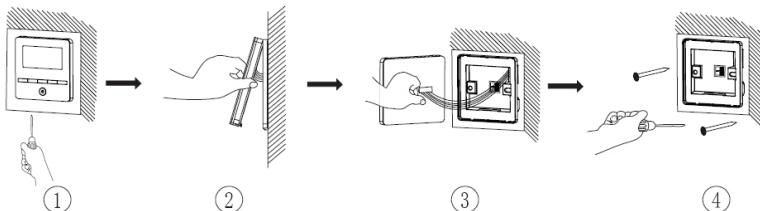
Diagrama de desmontaje del controlador por cable
